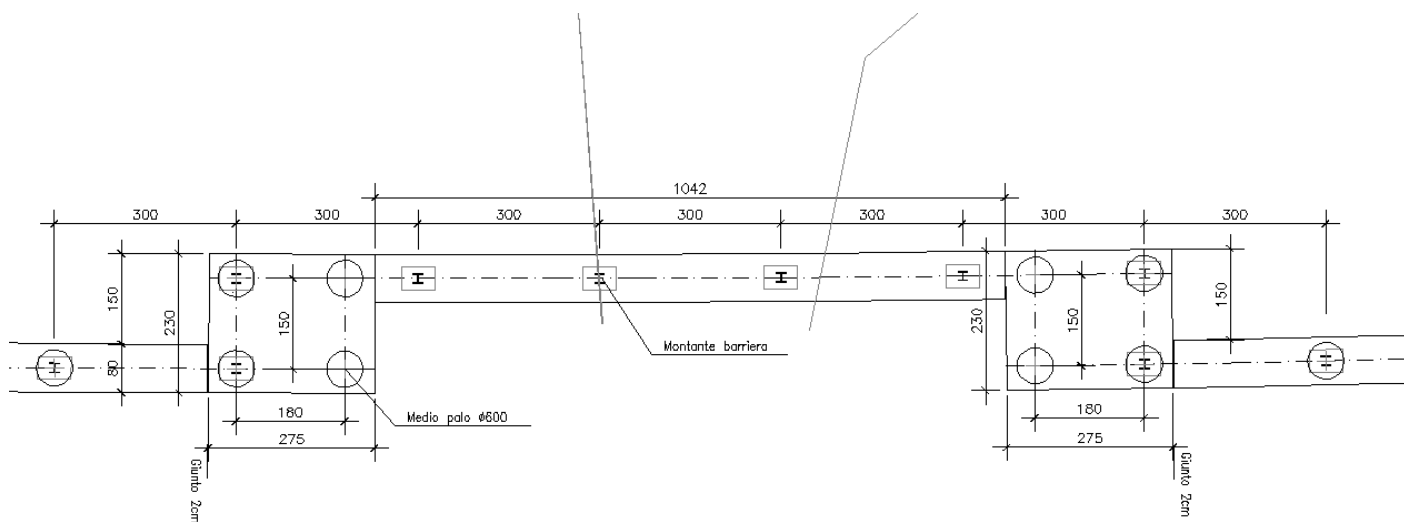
Fondazione scavalco L= 10.40 m - Pianta
